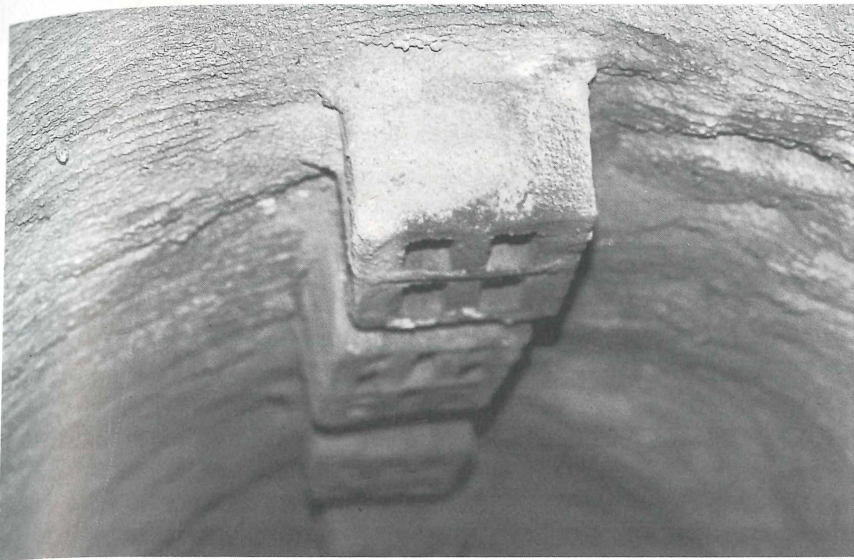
„Fledermaussteine“ in der Sanierungsstrecke im Permer Stollen.
